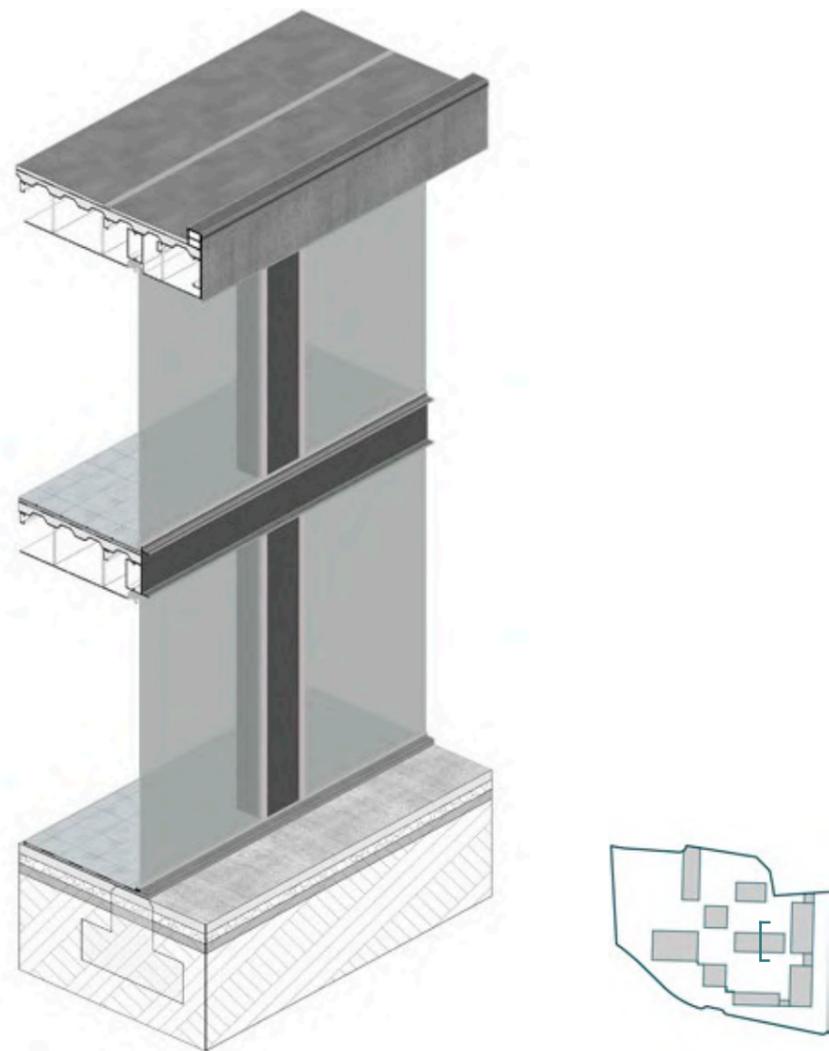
| Elevación, sección y detalles aula colegio | Fuente: Elaboración Propia
